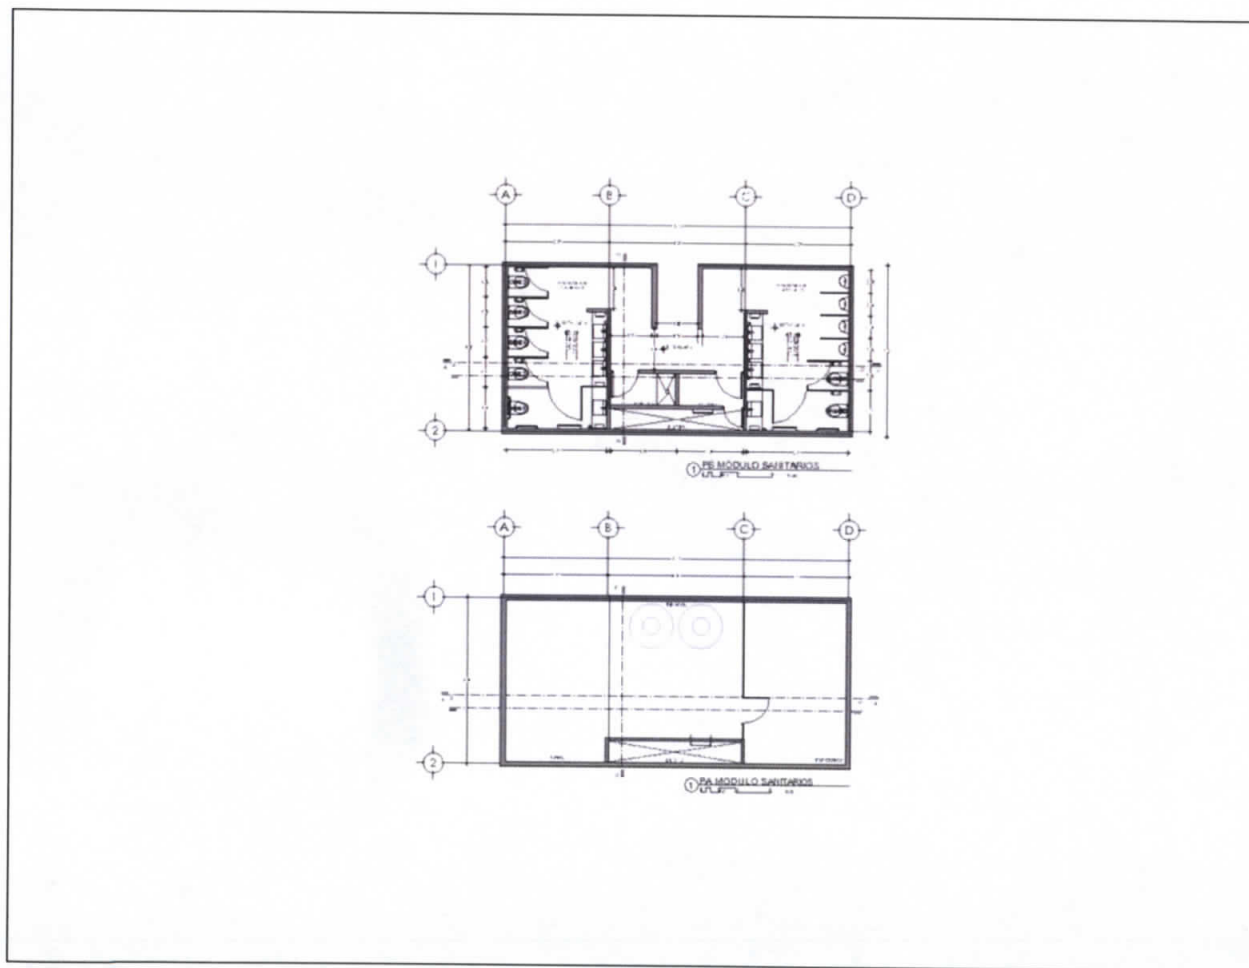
Planta arquitectónica, Módulo de baños, Parque Temático del Agua de Tabasco. (FUENTE: Coordinación de Vinculación, Facultad de Arquitectura 2014)
